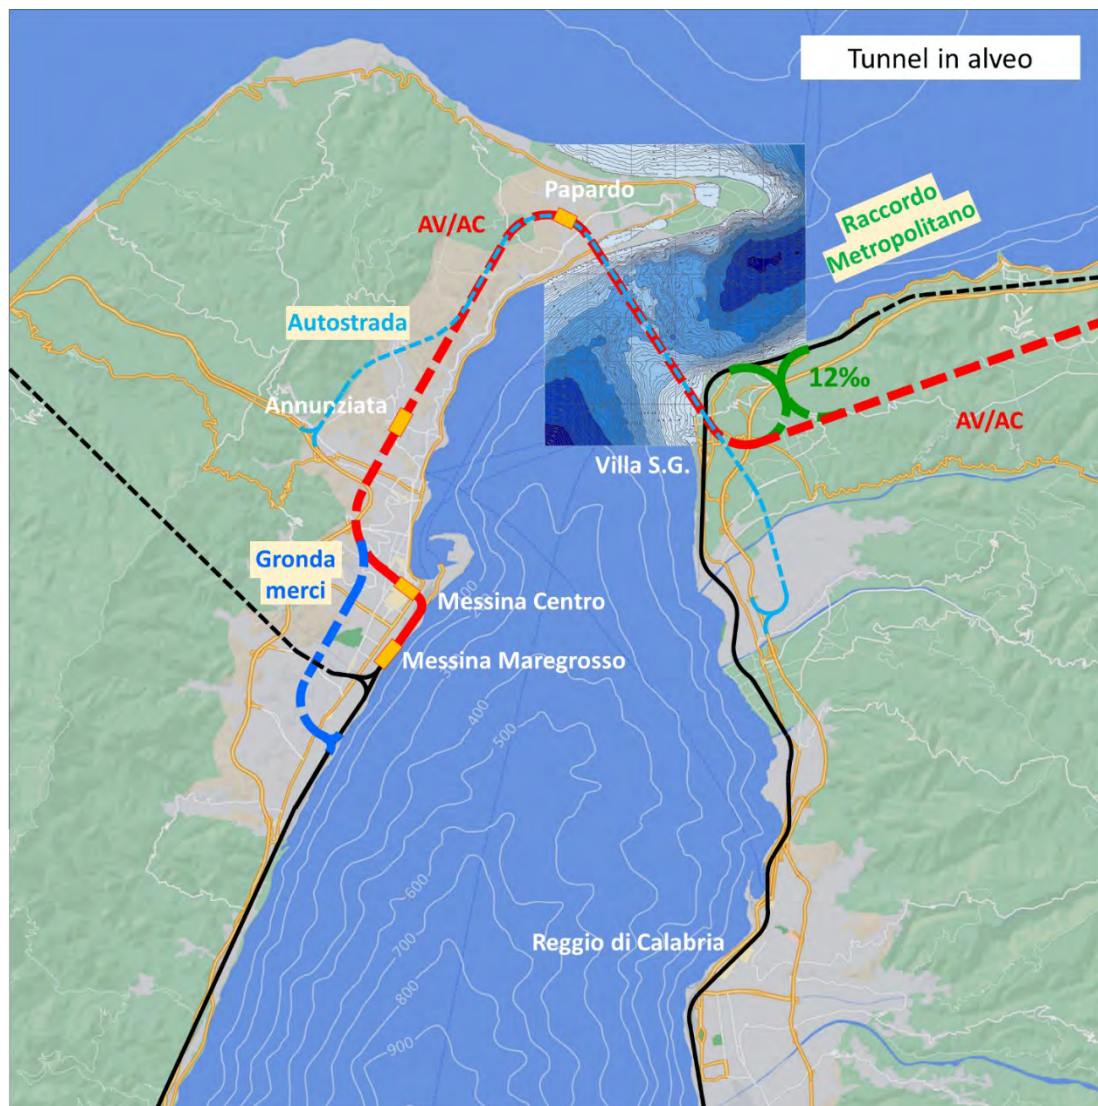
Tunnel alveo tra Ganzirri e Villa S.G.- Tracciato ferroviario – Planimetria
